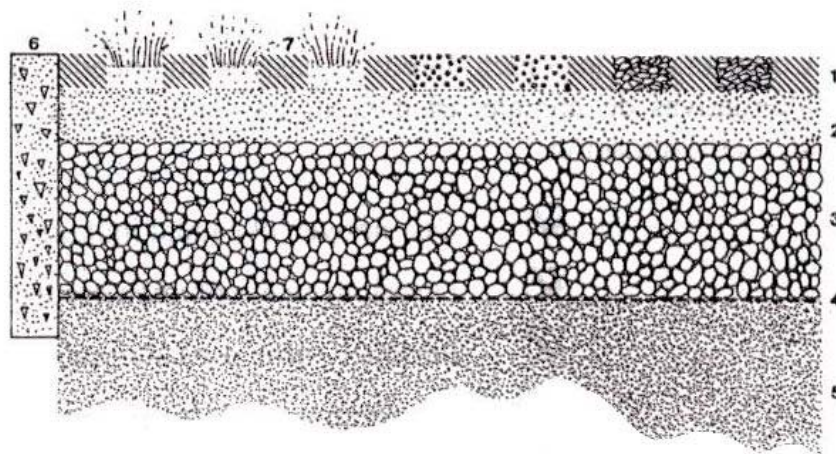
Esquema de los elementos principales de un pavimento celular. 1.- Carpeta de rodado, 2.- Cama de arena y filtro granular, 3.- Subbase, 4.- Geotextil, 5.- Subrasante o suelo inalterado, 6.- Confinamiento lateral.
